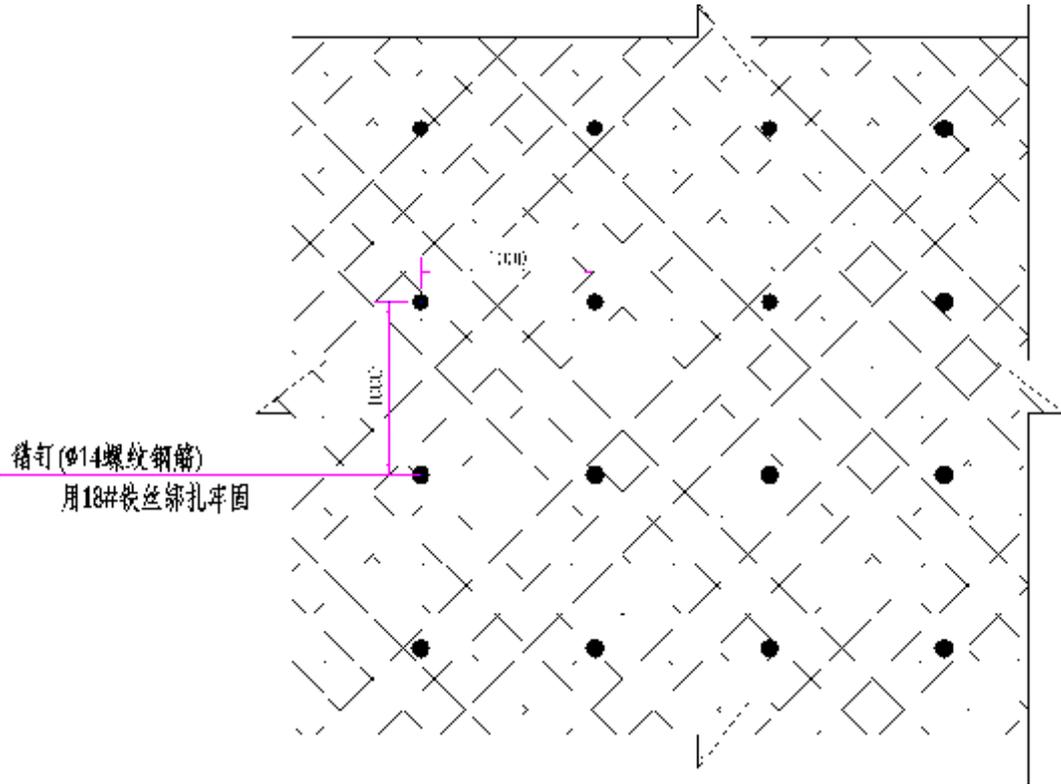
锚钉挂网布置示意图 (标注单位: mm)
